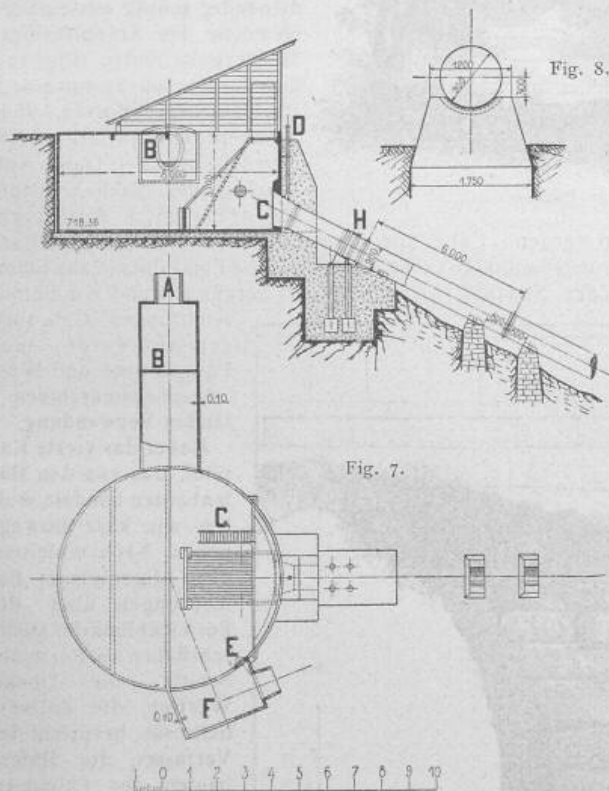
Grundriss und Schnitt des Reservoirs nebst Schnitt der Expansionsvorrichtung. 1:250.
